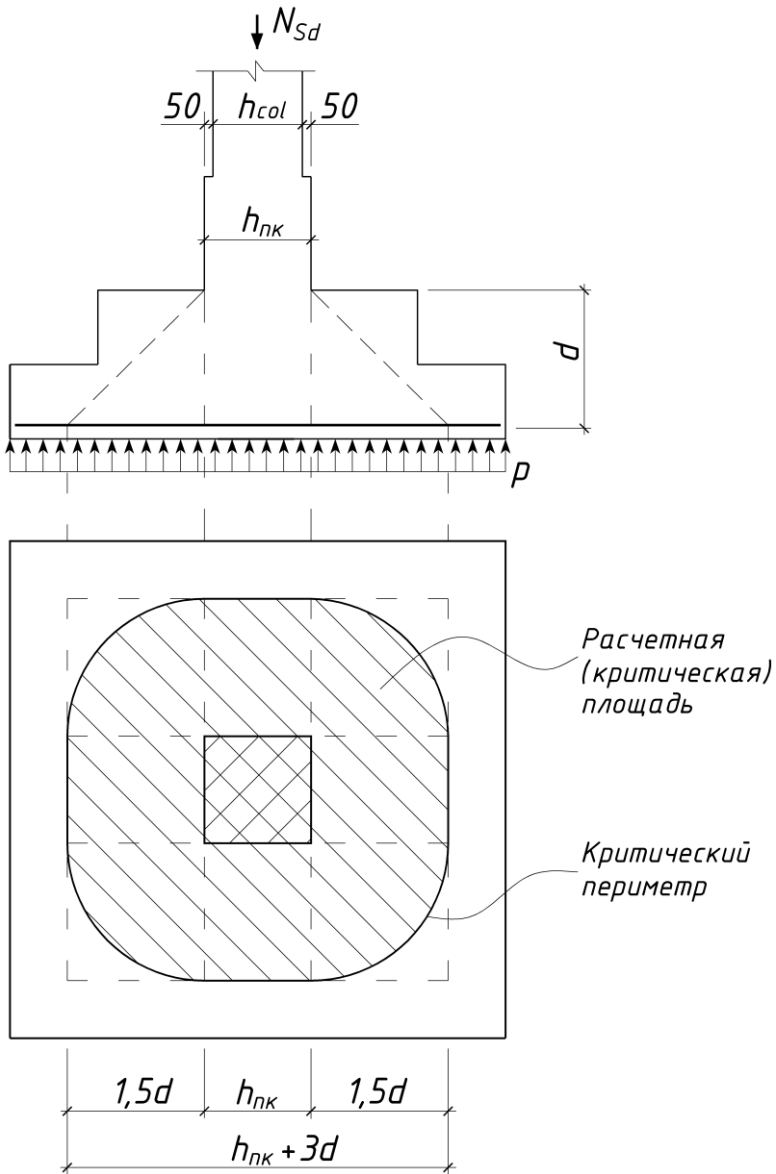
Расчетная схема фундамента при проверке на продавливание
